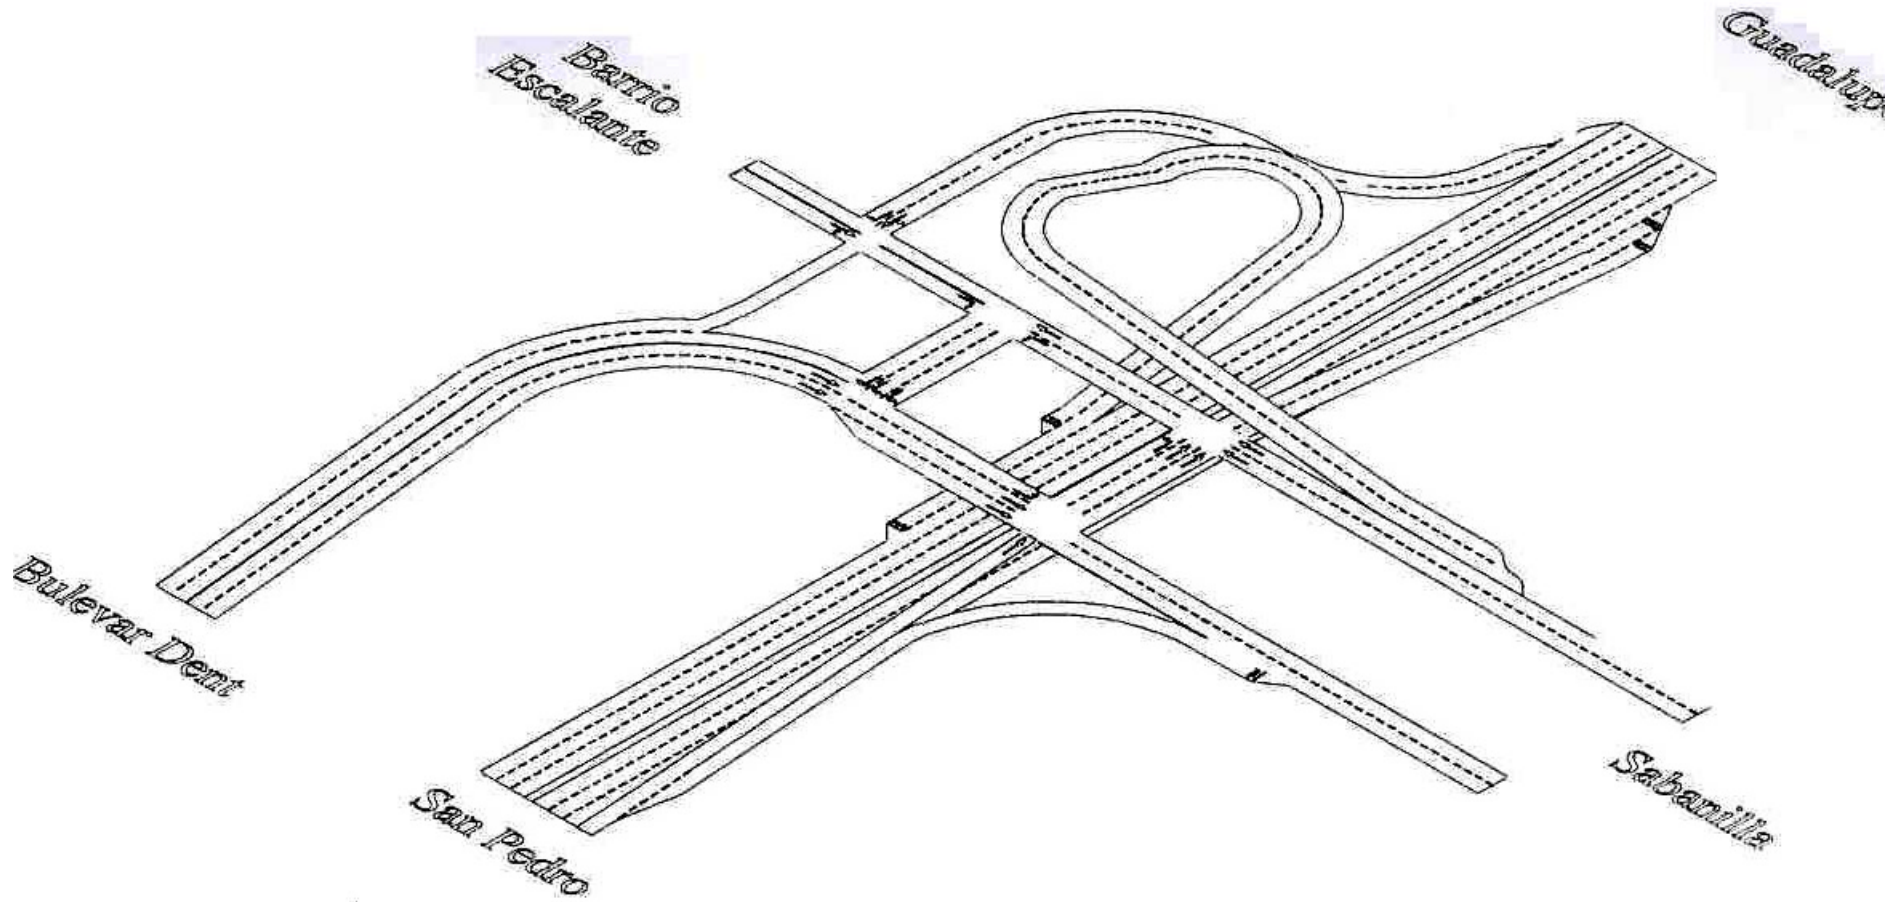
Intersección a desnivel sobre la actual Rotonda La Bandera. (Fuente: INGETrans, 1999)
